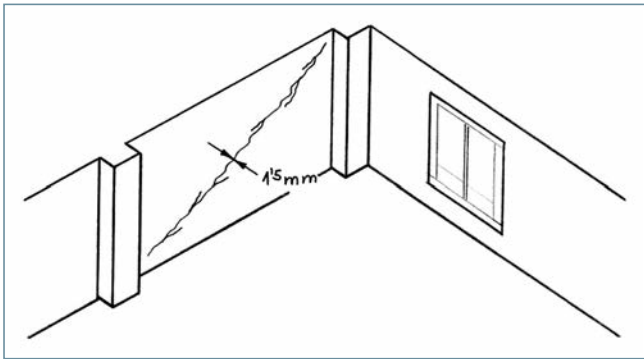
Vista según C (figura 3) a la altura de la 1ª planta.
